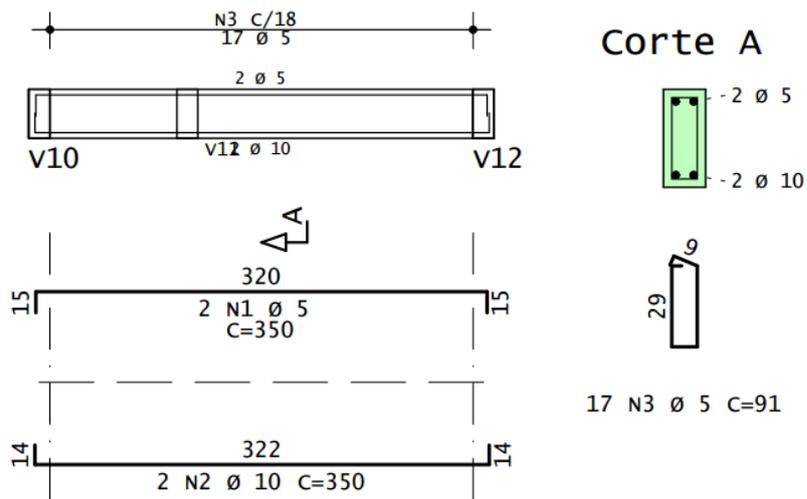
Armadura da viga baldrame V6 – pavimento térreo (nível 0,00)
